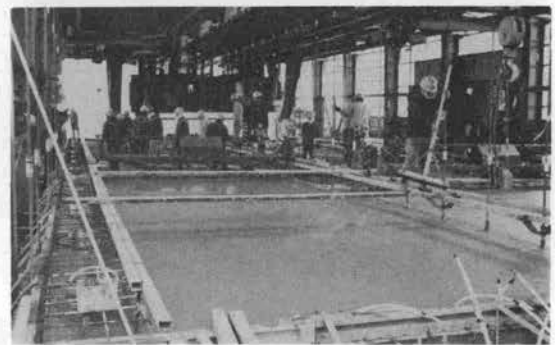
鉄筋、円筒型 わく、PC 鋼線の施工 ↓
